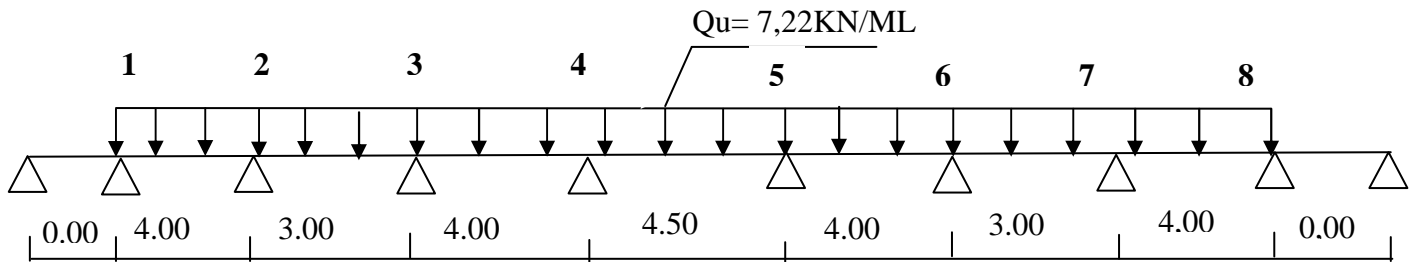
Diagramme des charges sur les poutrelles
